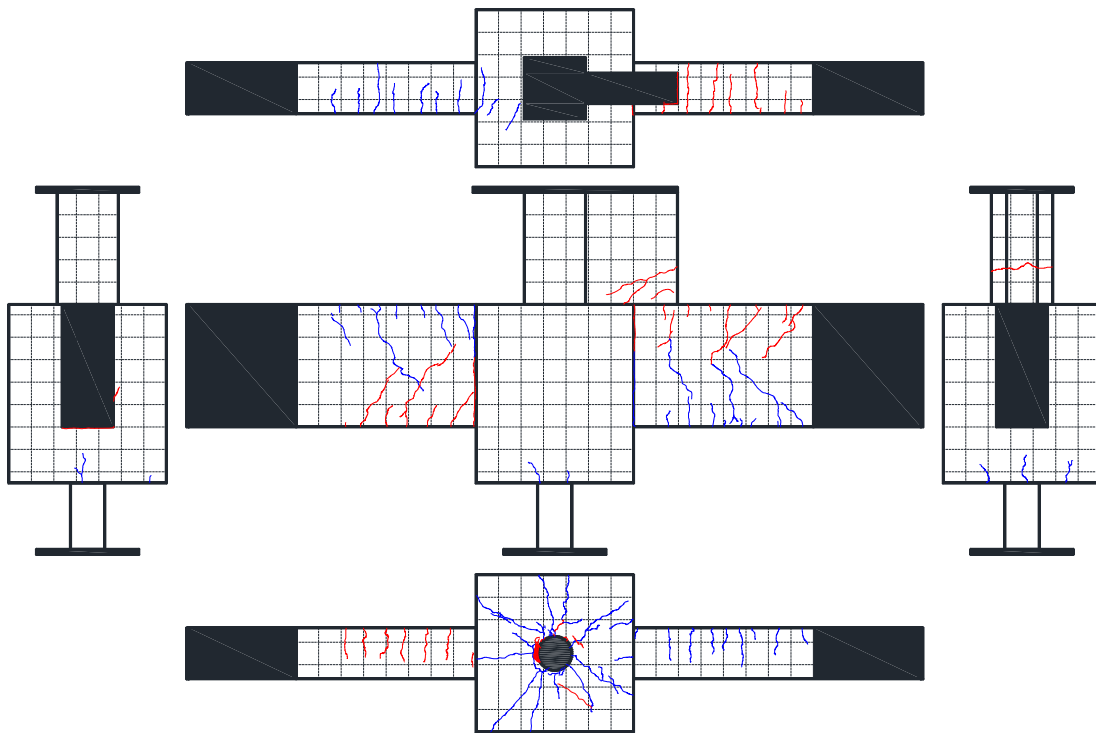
2. 3-57 試験体 DR-5 ひび割れ状況 (40cycle)
